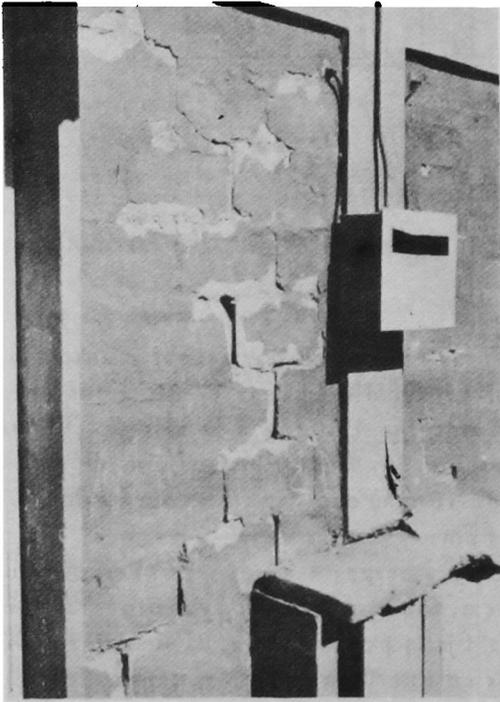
Detalle de grietas en un muro de bloques huecos. Población Pedro Aguirre Cerda.
